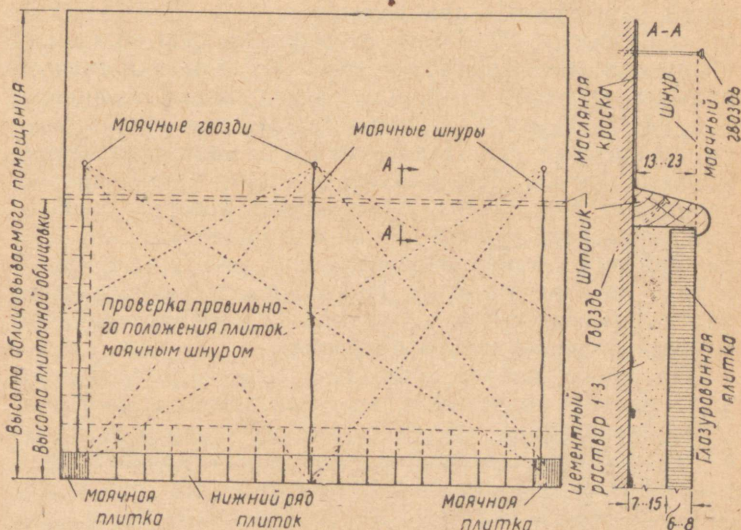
Облицовка стен глазурованными керамическими плитками.
